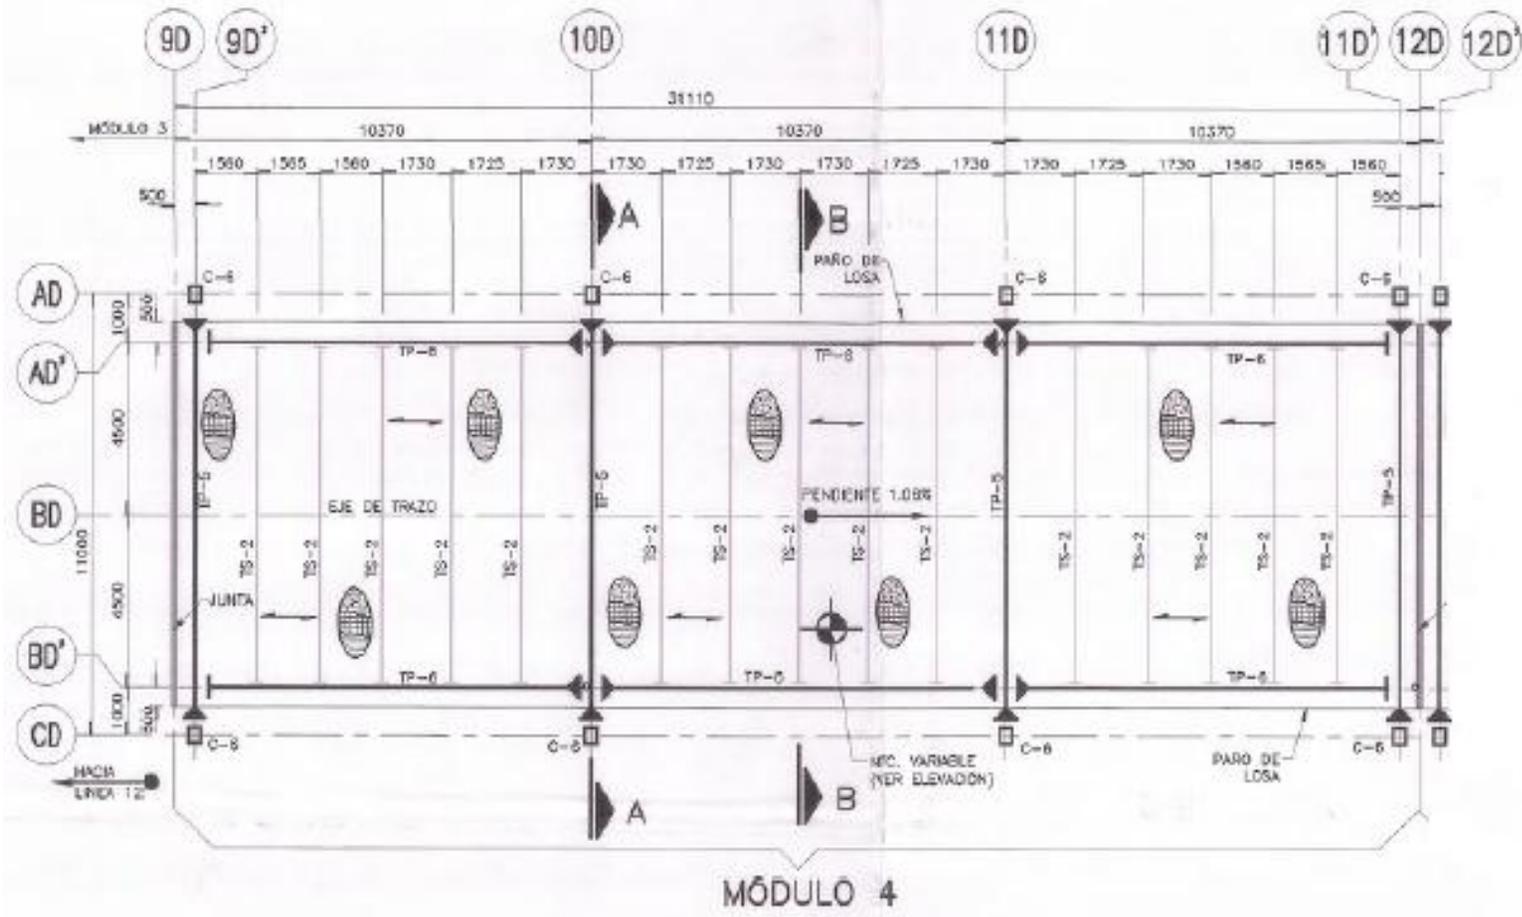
Planta de estructuración nivel azotea, módulo 4.
